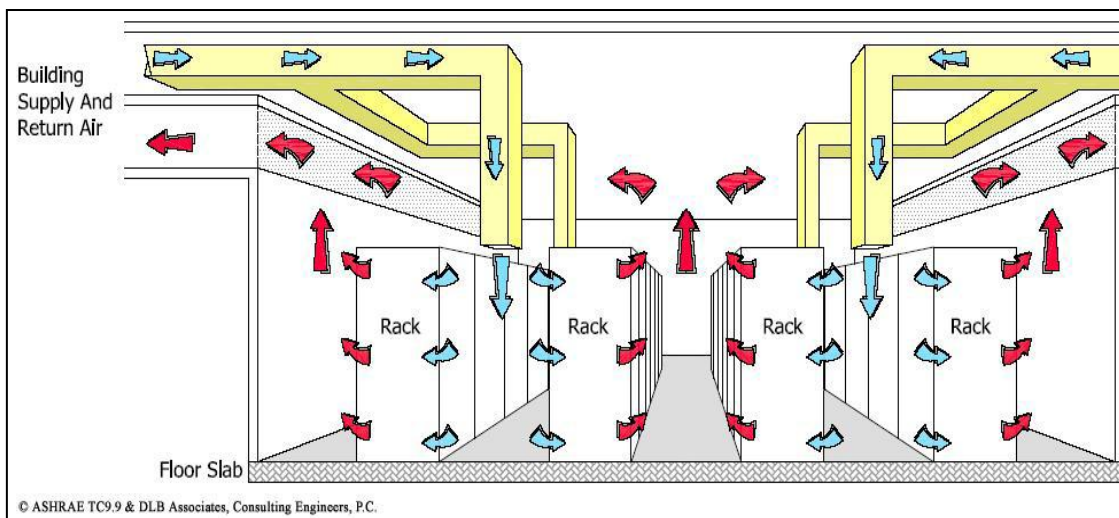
Sistema de climatização em sala sem pavimento falso sobrelevado [s74]
